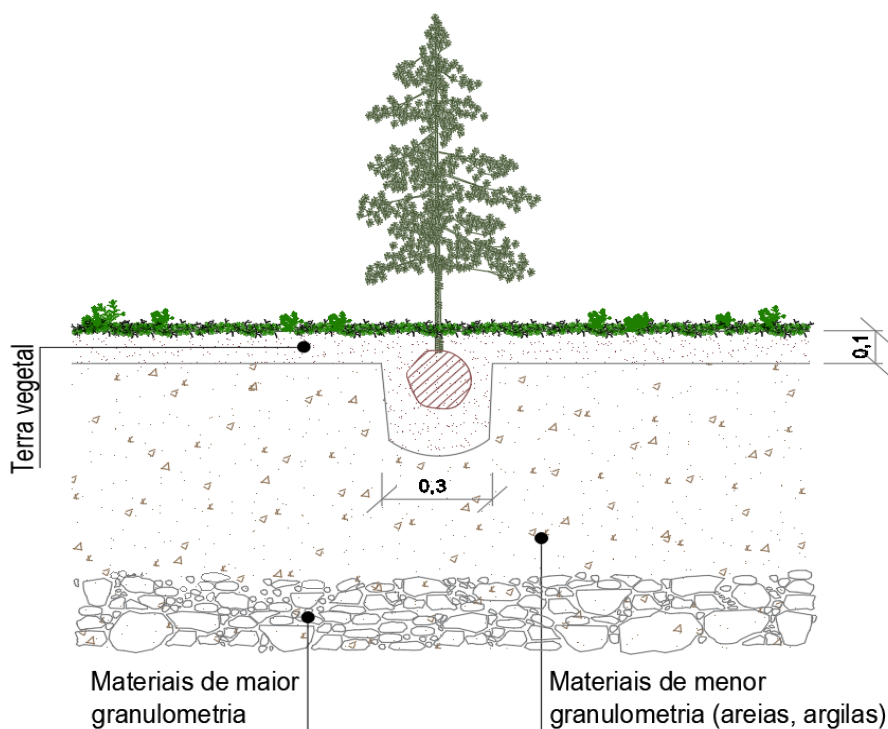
Desenho esquemático da metodologia de plantação, camada e bolsas de terra vegetal para as plantações.
